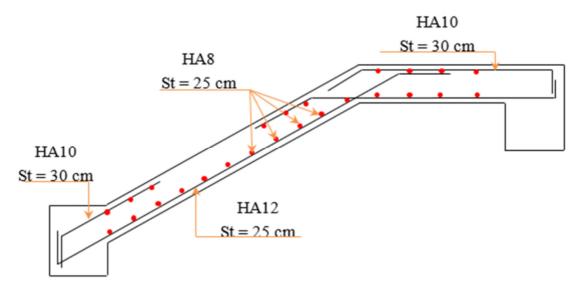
Schéma de ferraillage de l'escalier (volée 1 et 2).
